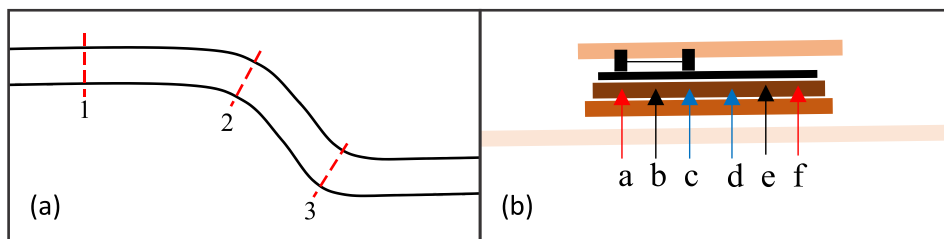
(a) traçado da via; (b) corte tipo para as seções 1, 2 e 3
